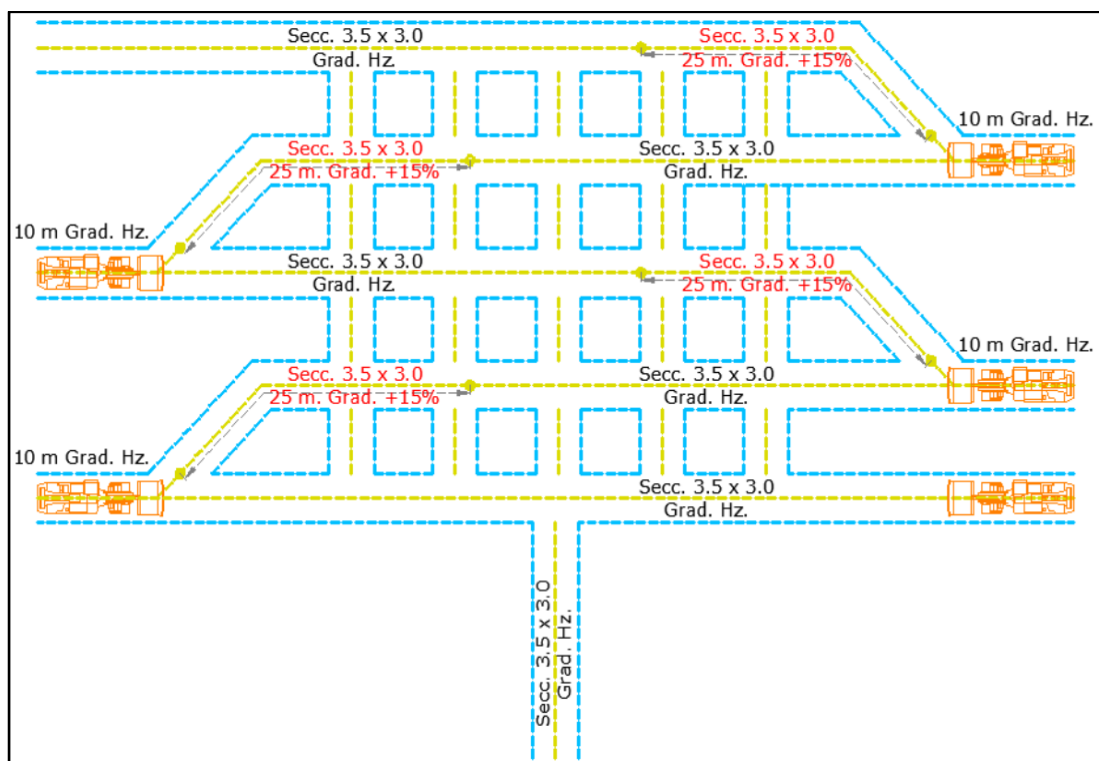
Alternativa ZIGZAG vista en planta fuente archivo SIMSA.
